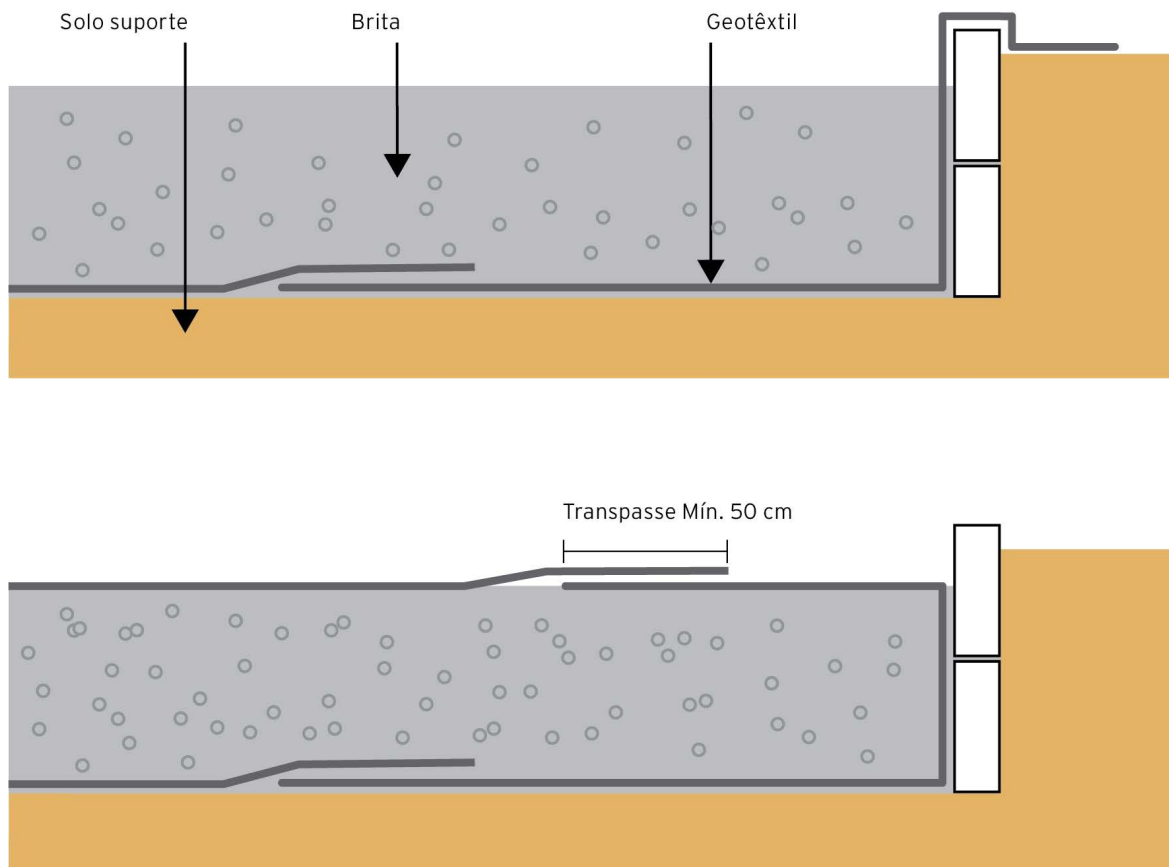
Detalhes do transpasse da manta geotêxtil que envolve a base porosa do pavimento permeável.
